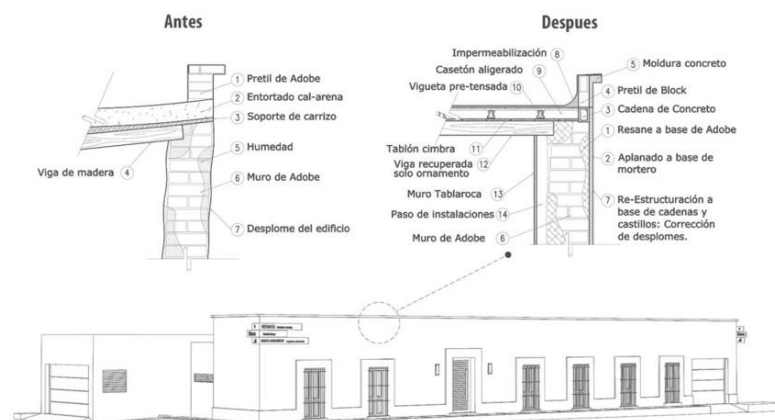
Detalle de corte por fachada, muros de adobe. Fuente: Archdaily
